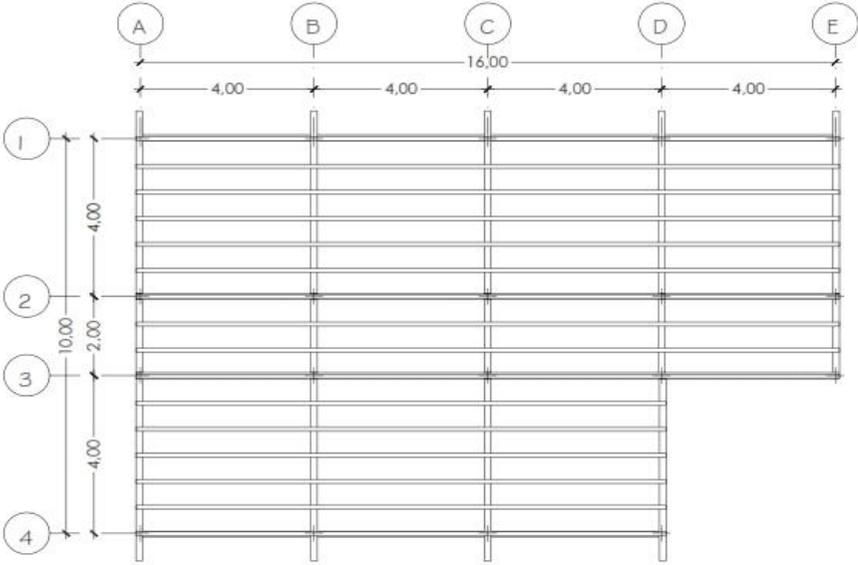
Planta de cubierta(Tipología 3)-Esc:1/100
